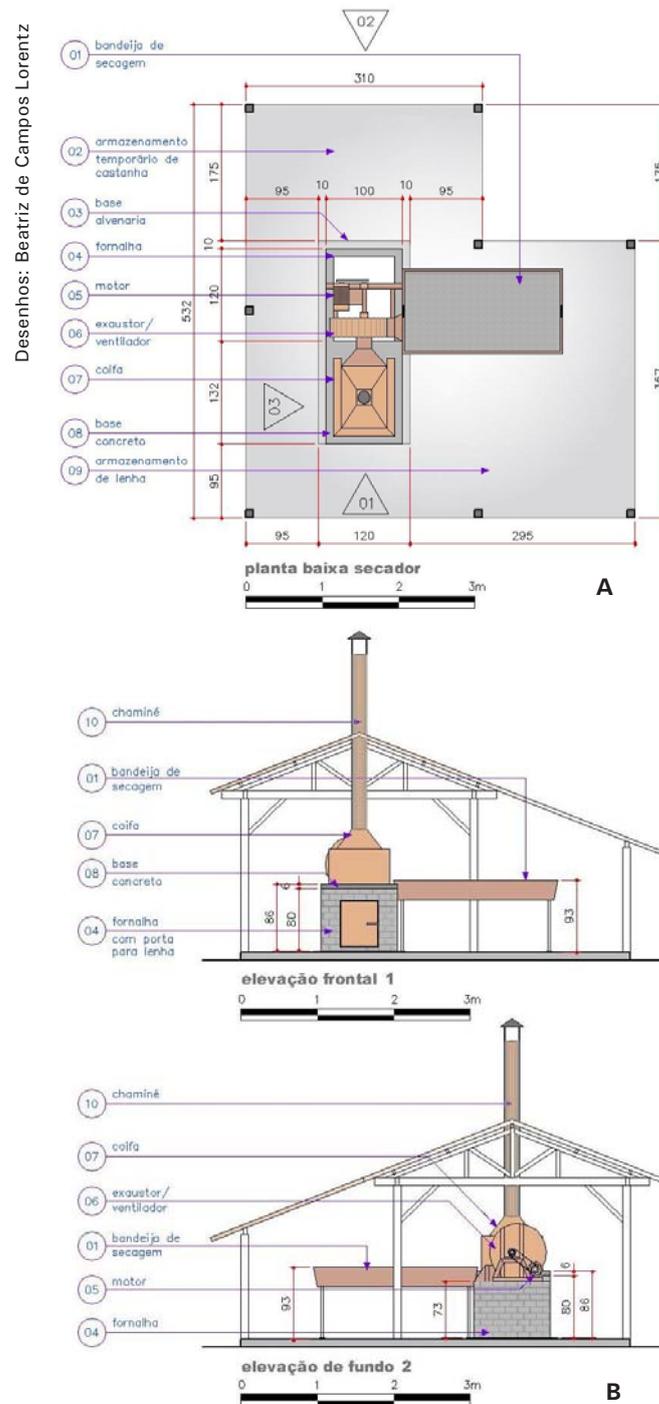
Desenhos da planta baixa (A), elevação frontal (B – superior) e elevação de fundo (B – inferior) do secador a ar aquecido forçado artificialmente com camada fixa.
